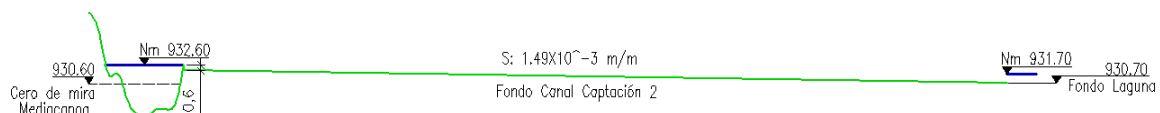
Esquema de la sección transversal para la captación 2. K215+580
